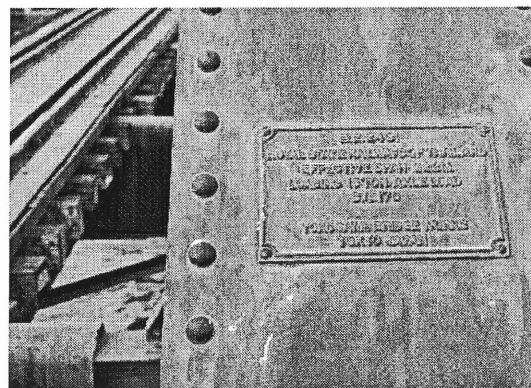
戦後補償で再建された平行弦トラス橋の銘板
